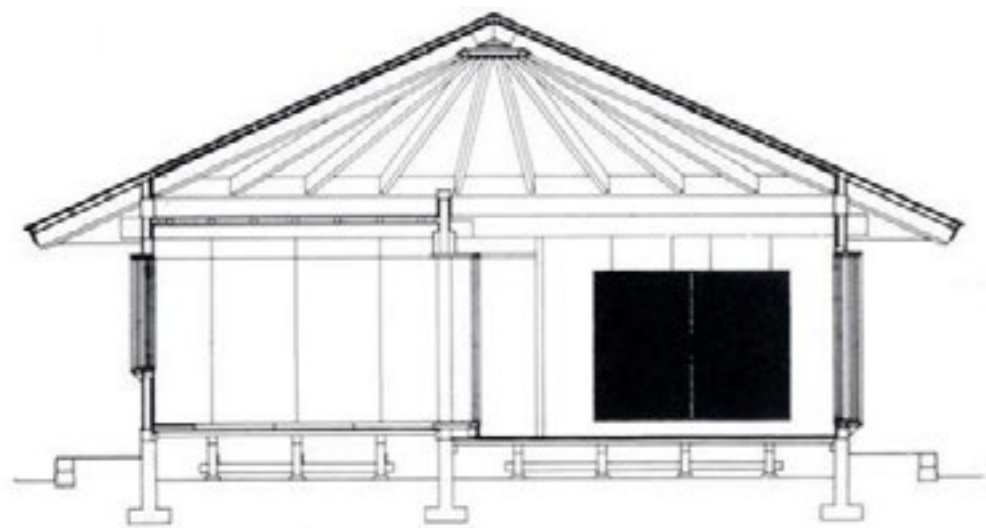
Umbrella House, sección. Kazuo Shinohara, 1961
